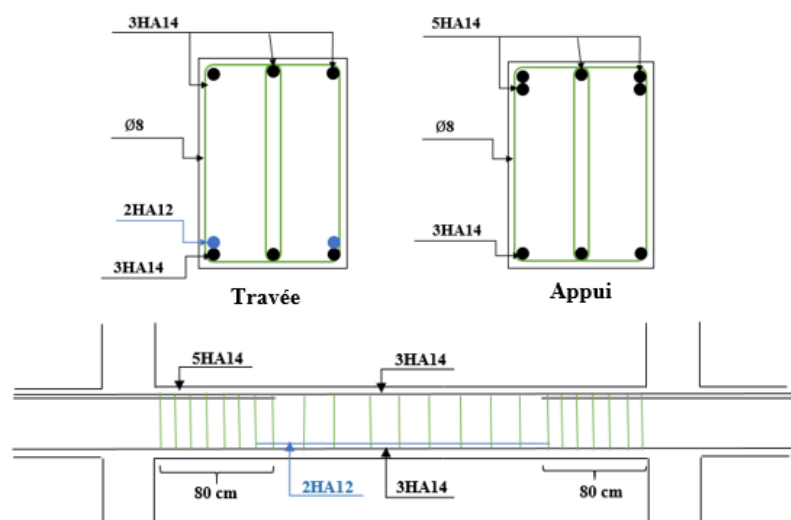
Schéma de ferrailages de la poutre principale (30×40).
